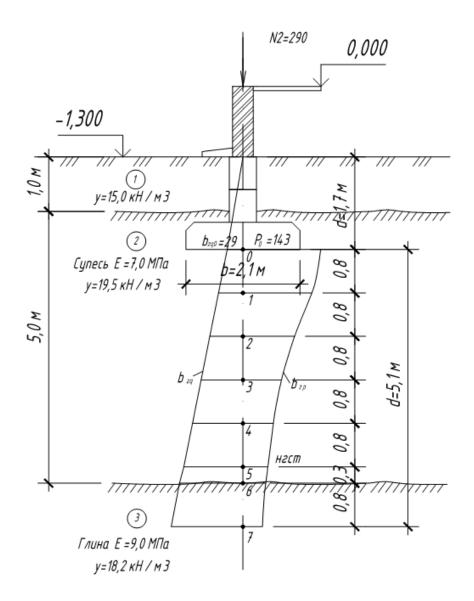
Схема расчета осадки фундамента на естественном основании
